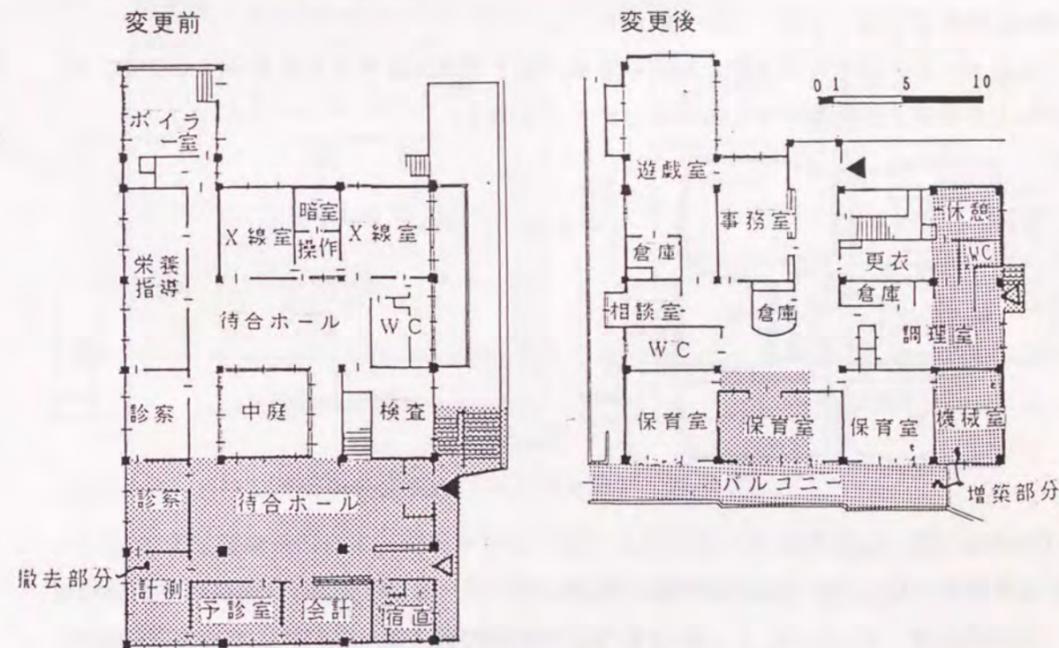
<92>第3ひもんや保育園（旧保健所）1階平面図
